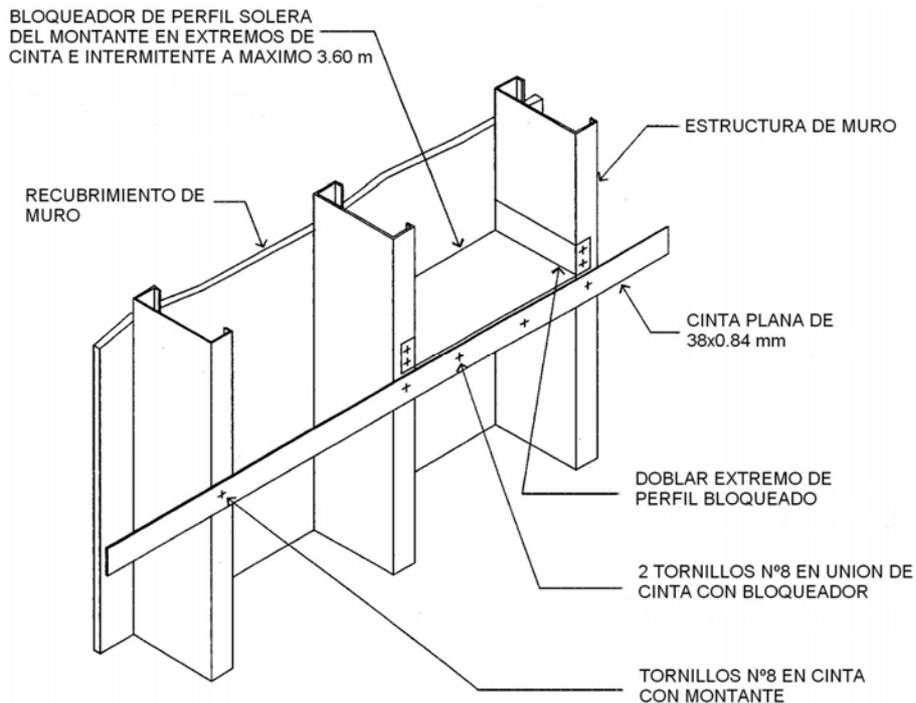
Detalle de arriostramiento con paneles en cara exterior y cinta metálica en cara interior;
